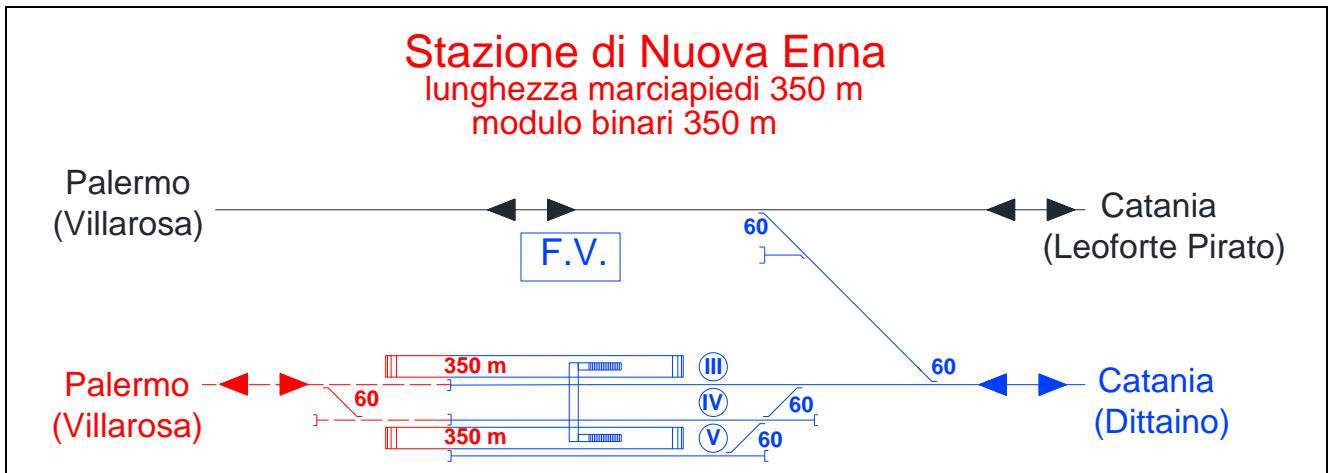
Layout funzionale di progetto – Stazione di Nuova Enna
